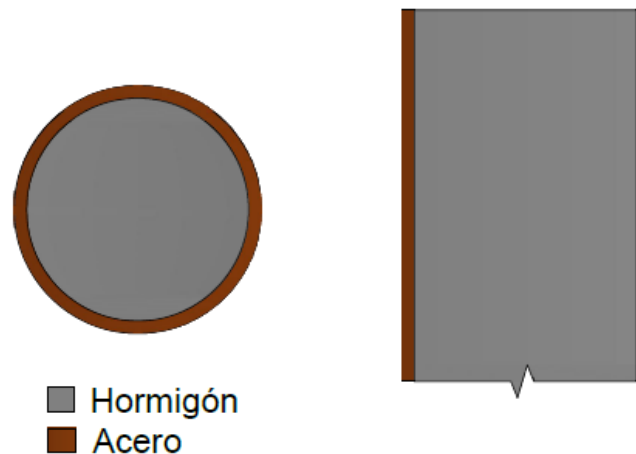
Esquema ilustrativo de los CFT (Concrete Filled Tube) sin refuerzo longitudinal.
